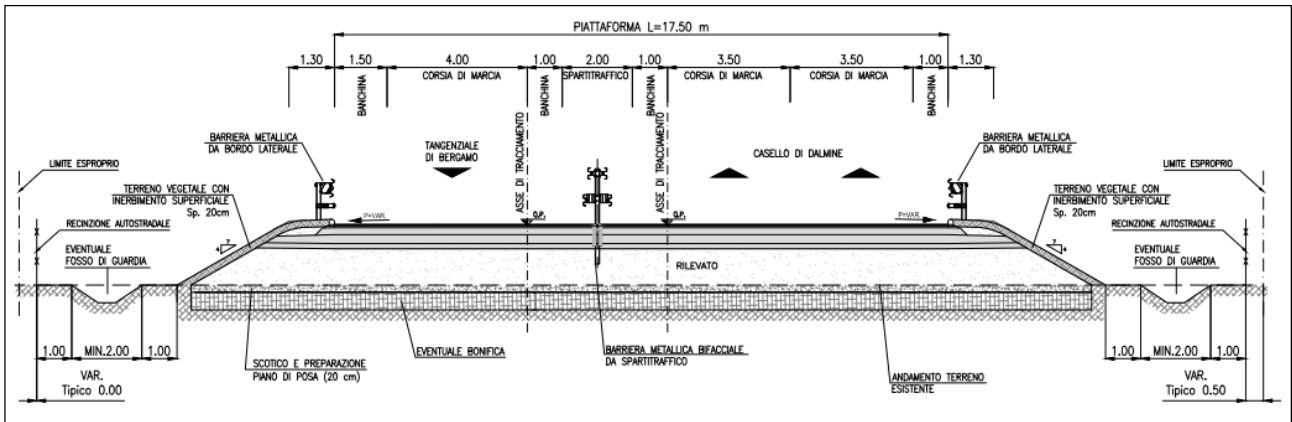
Sezione tipo rampa bidirezionale a 3 corsie
